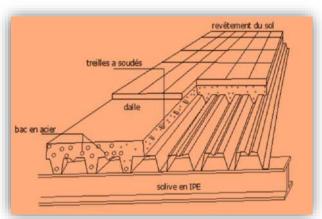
Détail d'un plancher collaborant Source: les auteurs
